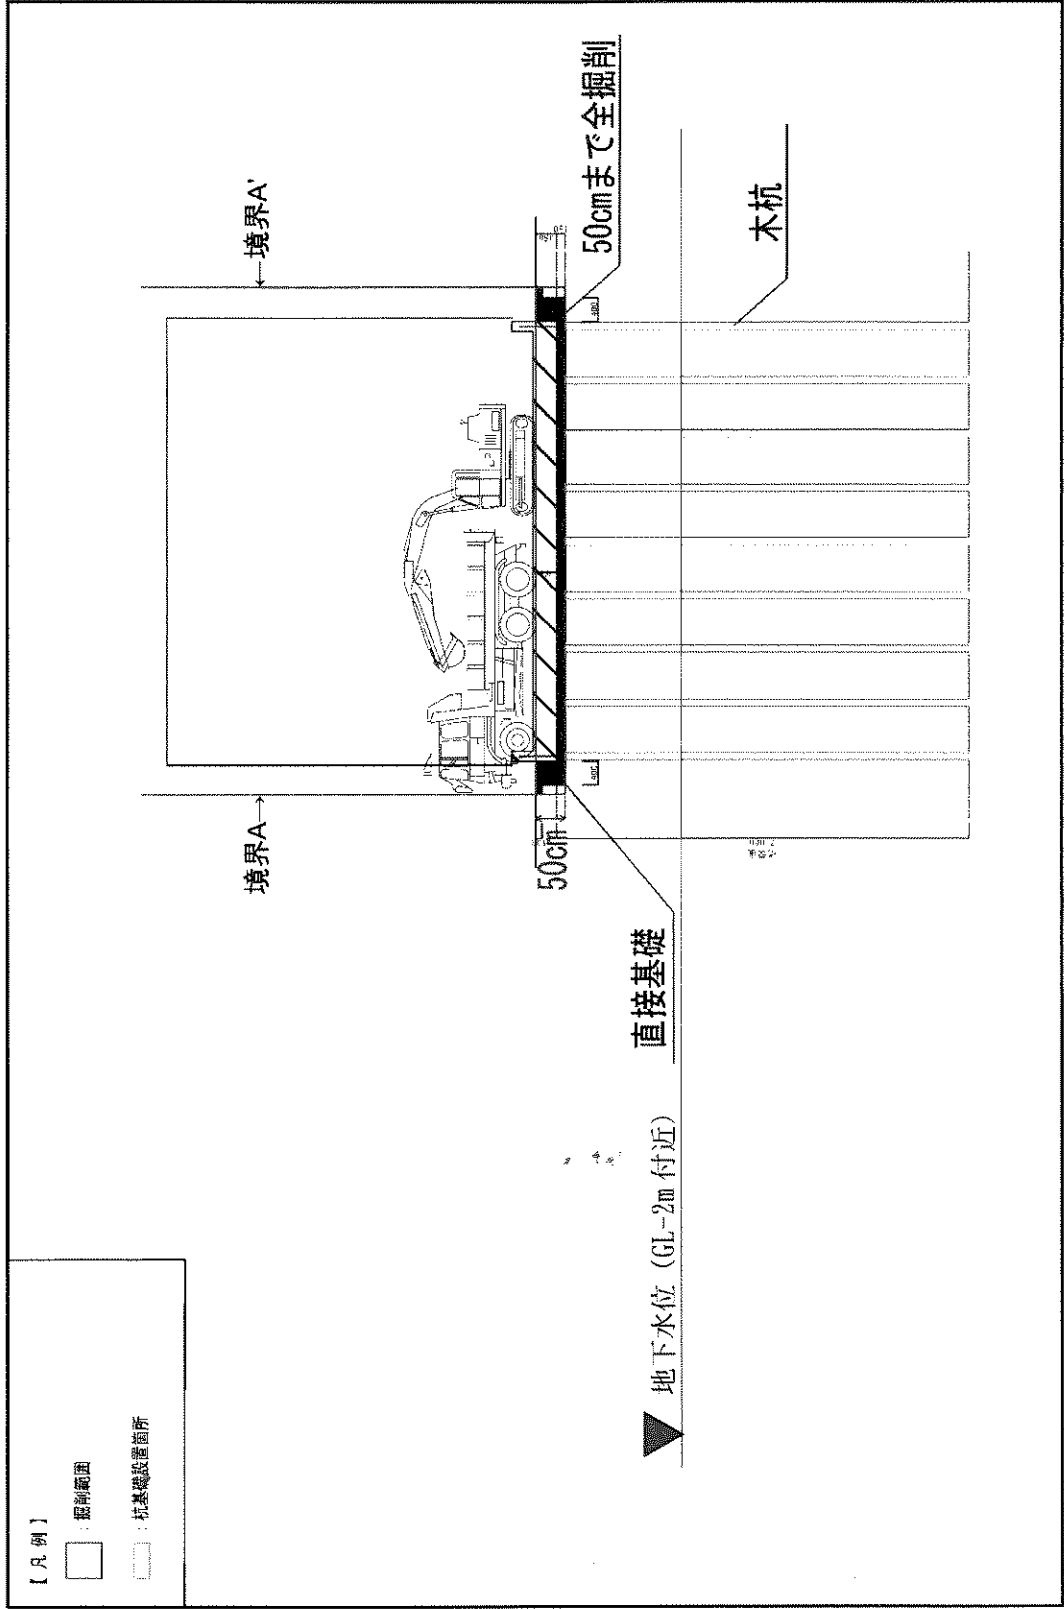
施工方法を明らかにした断面図 (木杭打設)
